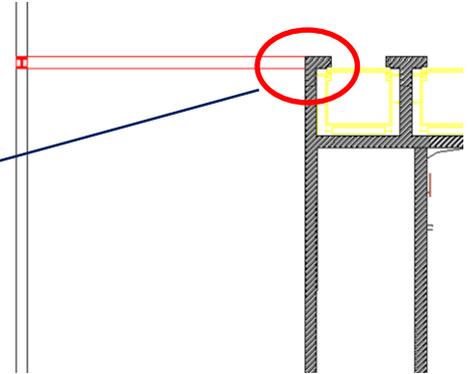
Vue en plan d'une poutre entre le poteau et le noyau central de la tour
